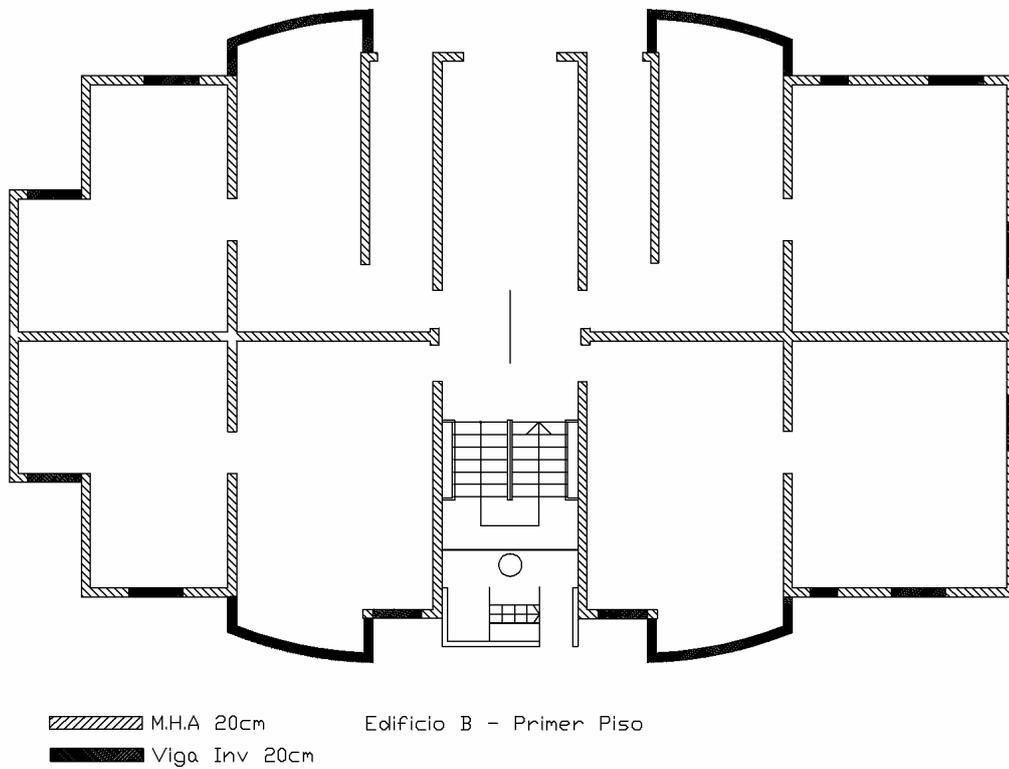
Edificio B, estructuración del Piso Tipo.
